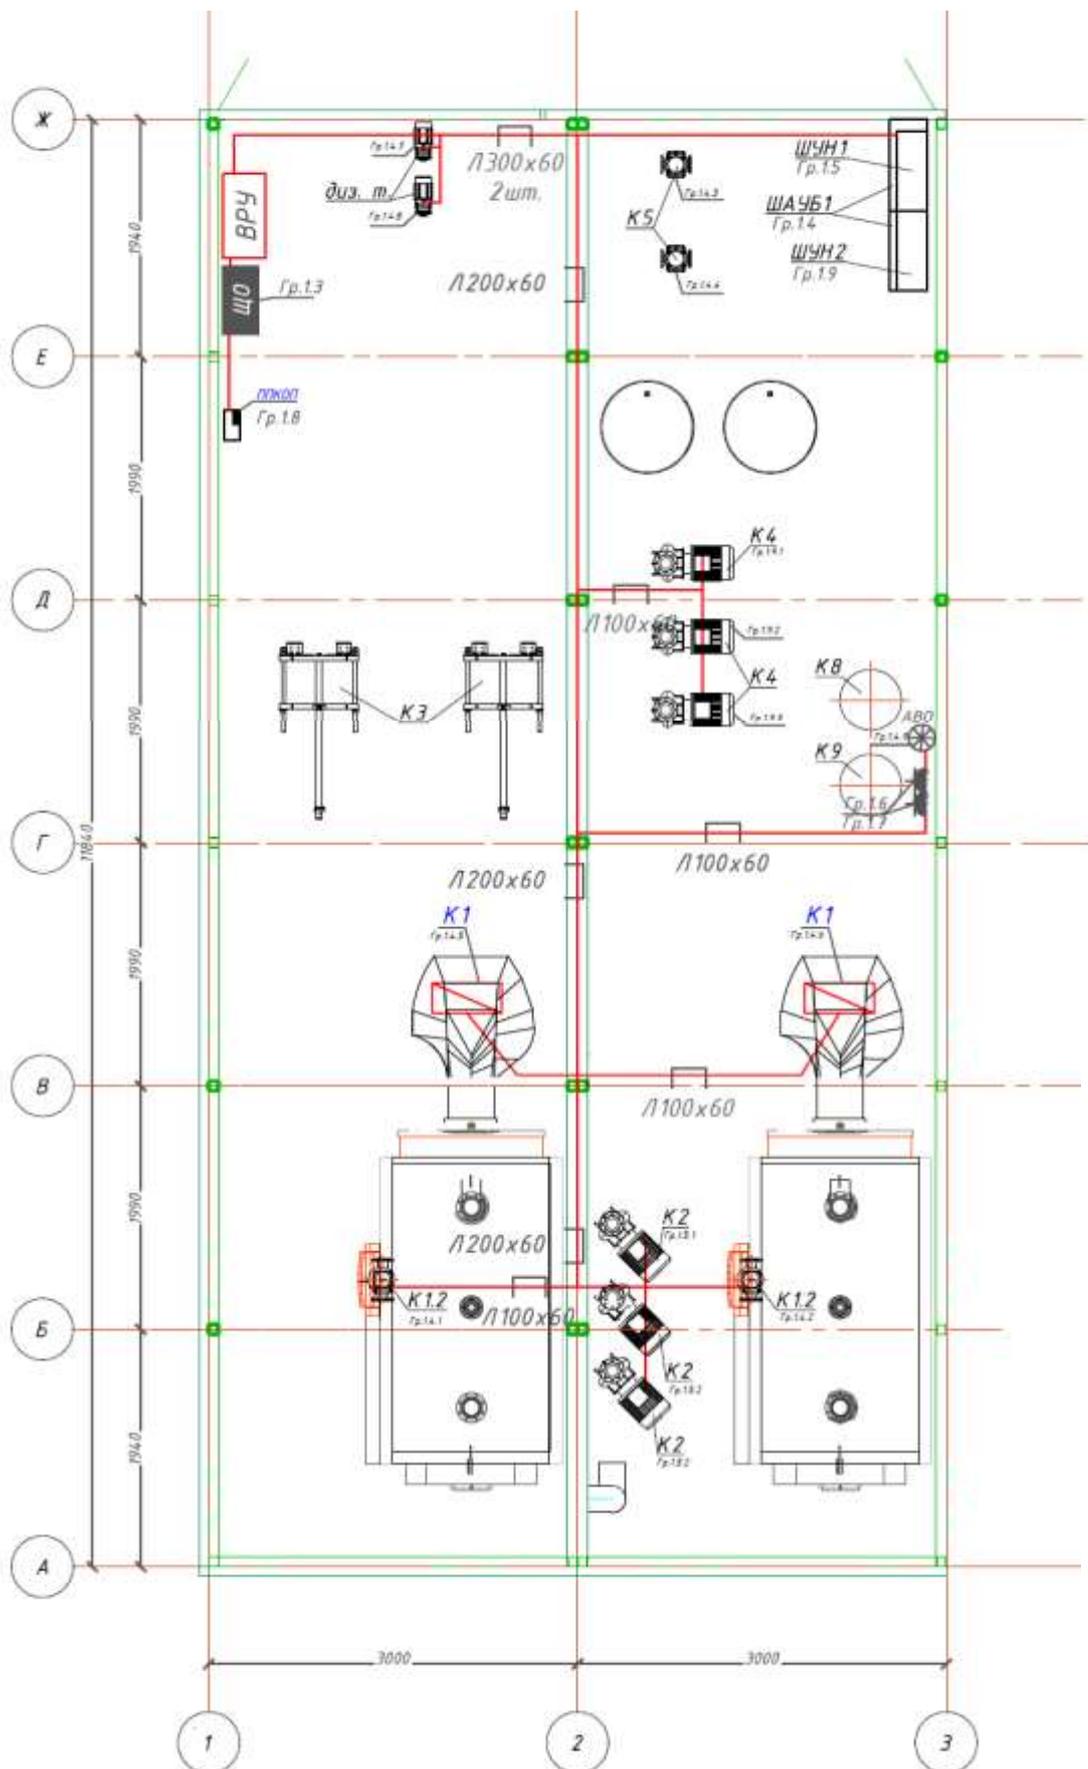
План прокладки распределительной сети блоков №1-3 котельной
